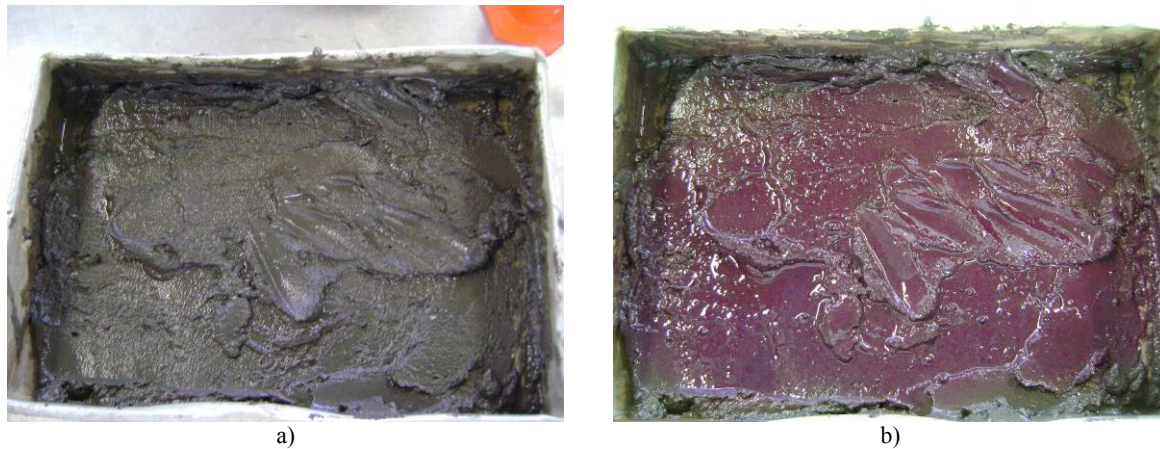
Pulverização da mistura de solo-cimento “bem misturada”, com um indicador pH: a) mistura de solo com calda de cimento; b) pulverização com fenolftaleína
